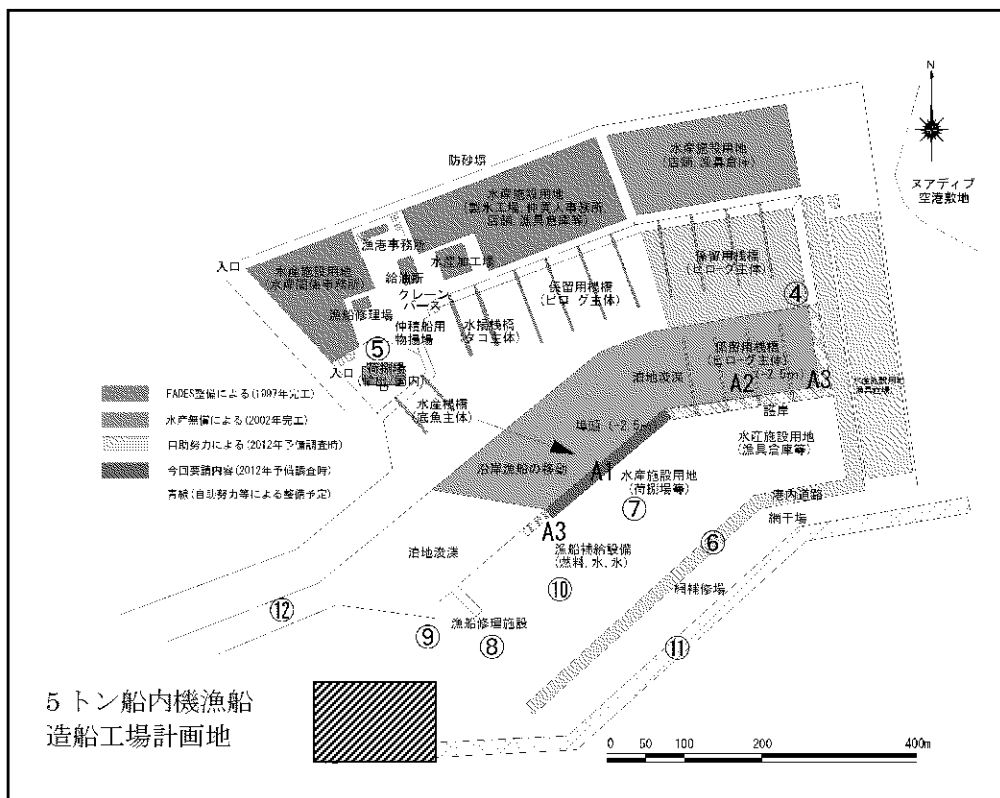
(1) ヌアディブ漁港拡張整備計画の要請施設配置図
